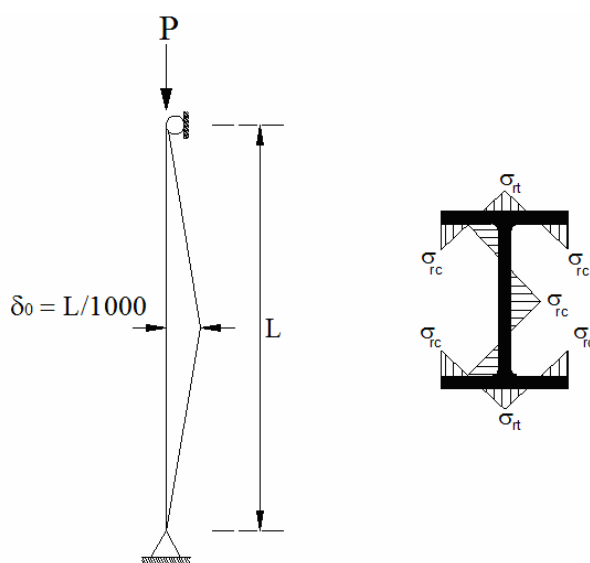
Pilar birrotulado com imperfeição inicial e tensão residual
